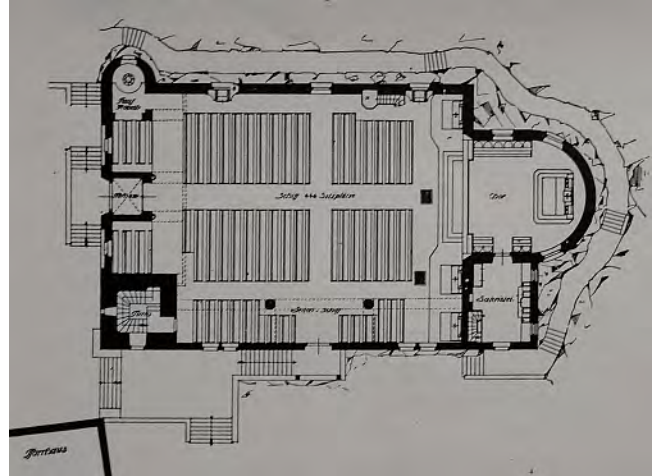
Bristen, kath. Kirche (Adolf Gaudy, 1910–11). Grundriss, dorfsseitig ergänzt durch ein mit Säulen abgesetztes Seitenschiff. – DCK 10 (1914), 296.
